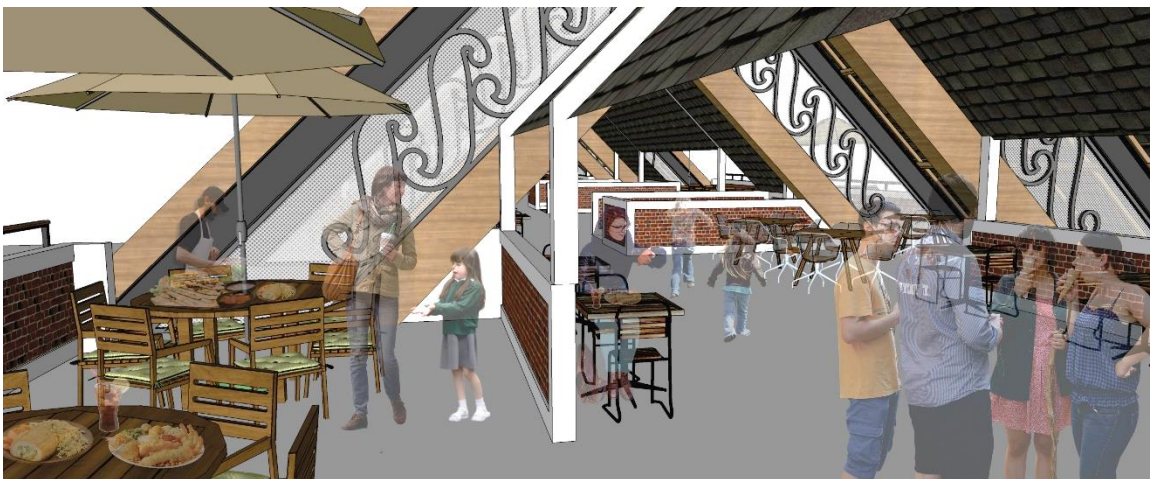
Interior pada area sirkulasi pada tengah bangunan
